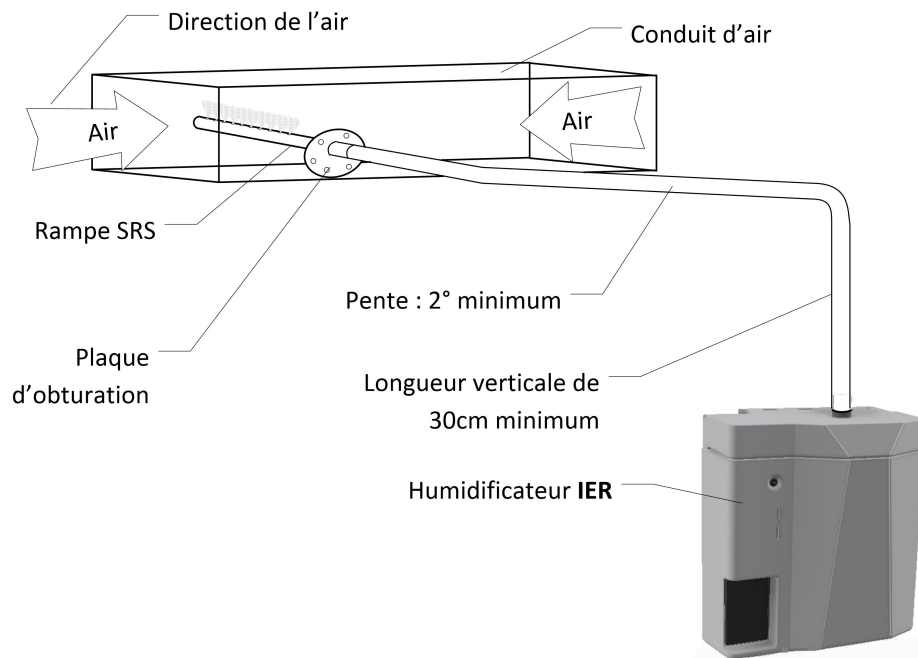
Installation des rampes SRS & SRSX (sans retour de condensât dédié)
